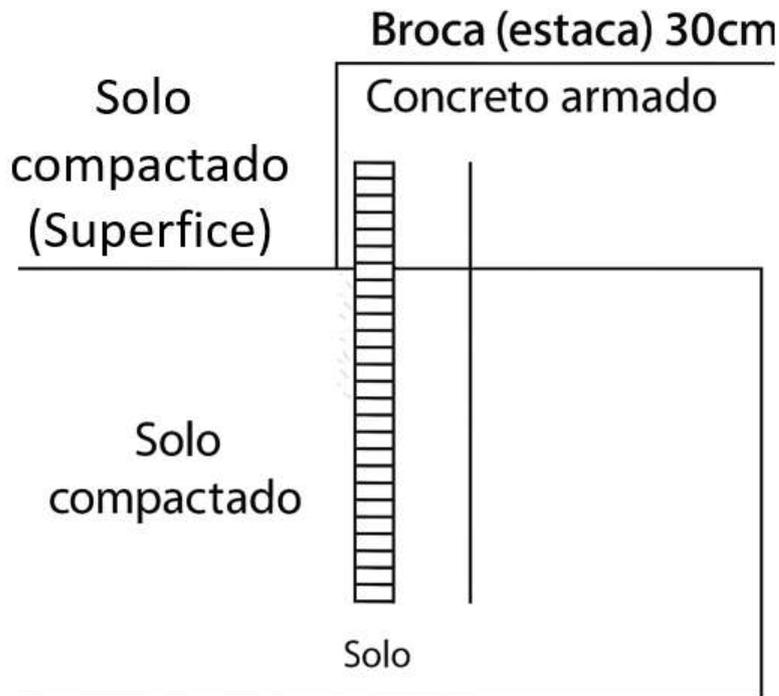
Detalhamento da fundação das estruturas dos painéis.
